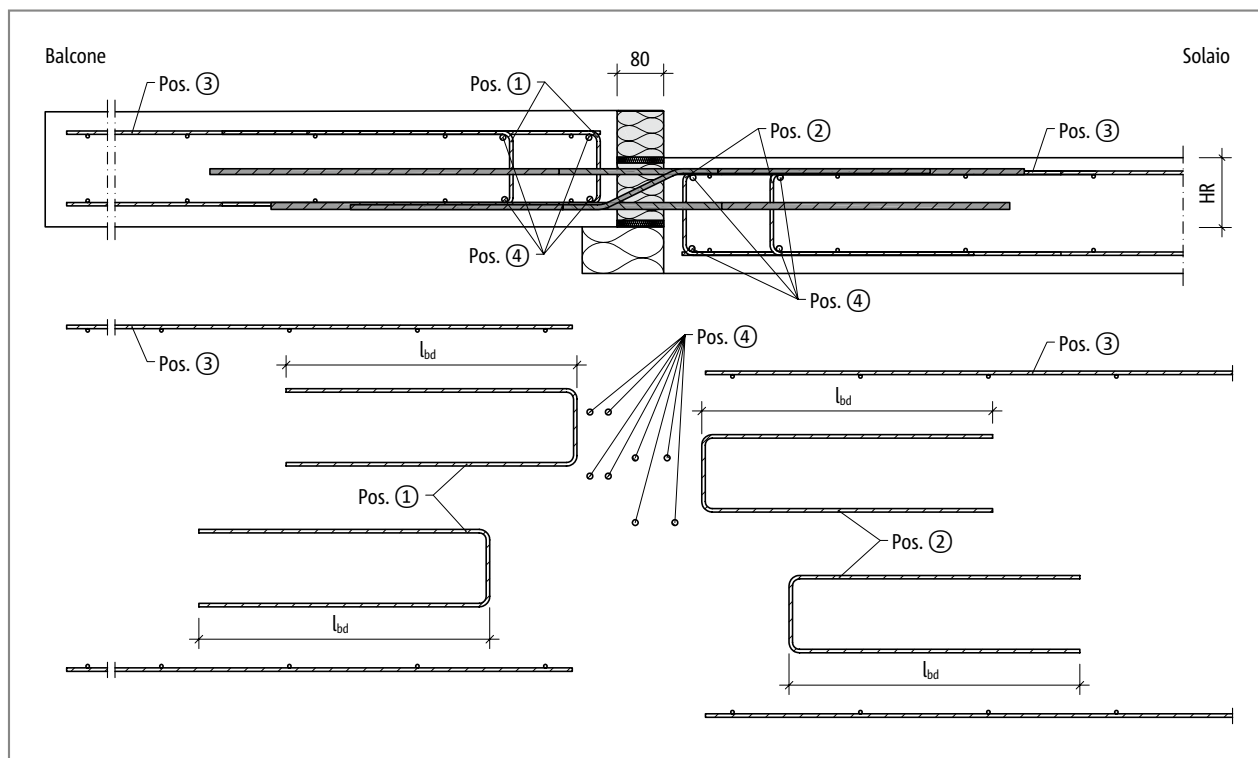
Schöck Isokorb® T tipo KL-OD/UD: armatura in opera
